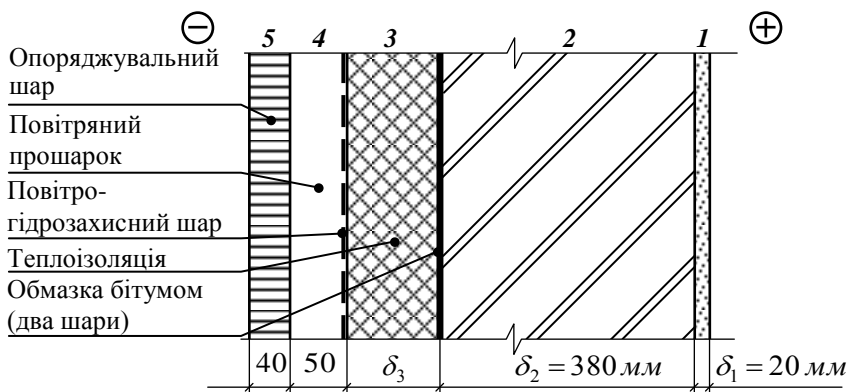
Розрахункова схема стіни вентиляованого фасаду
